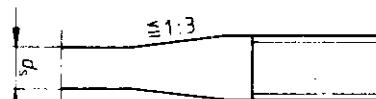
Aufgestauchtes Stabende mit Gewinde für verschraubten Stoß
